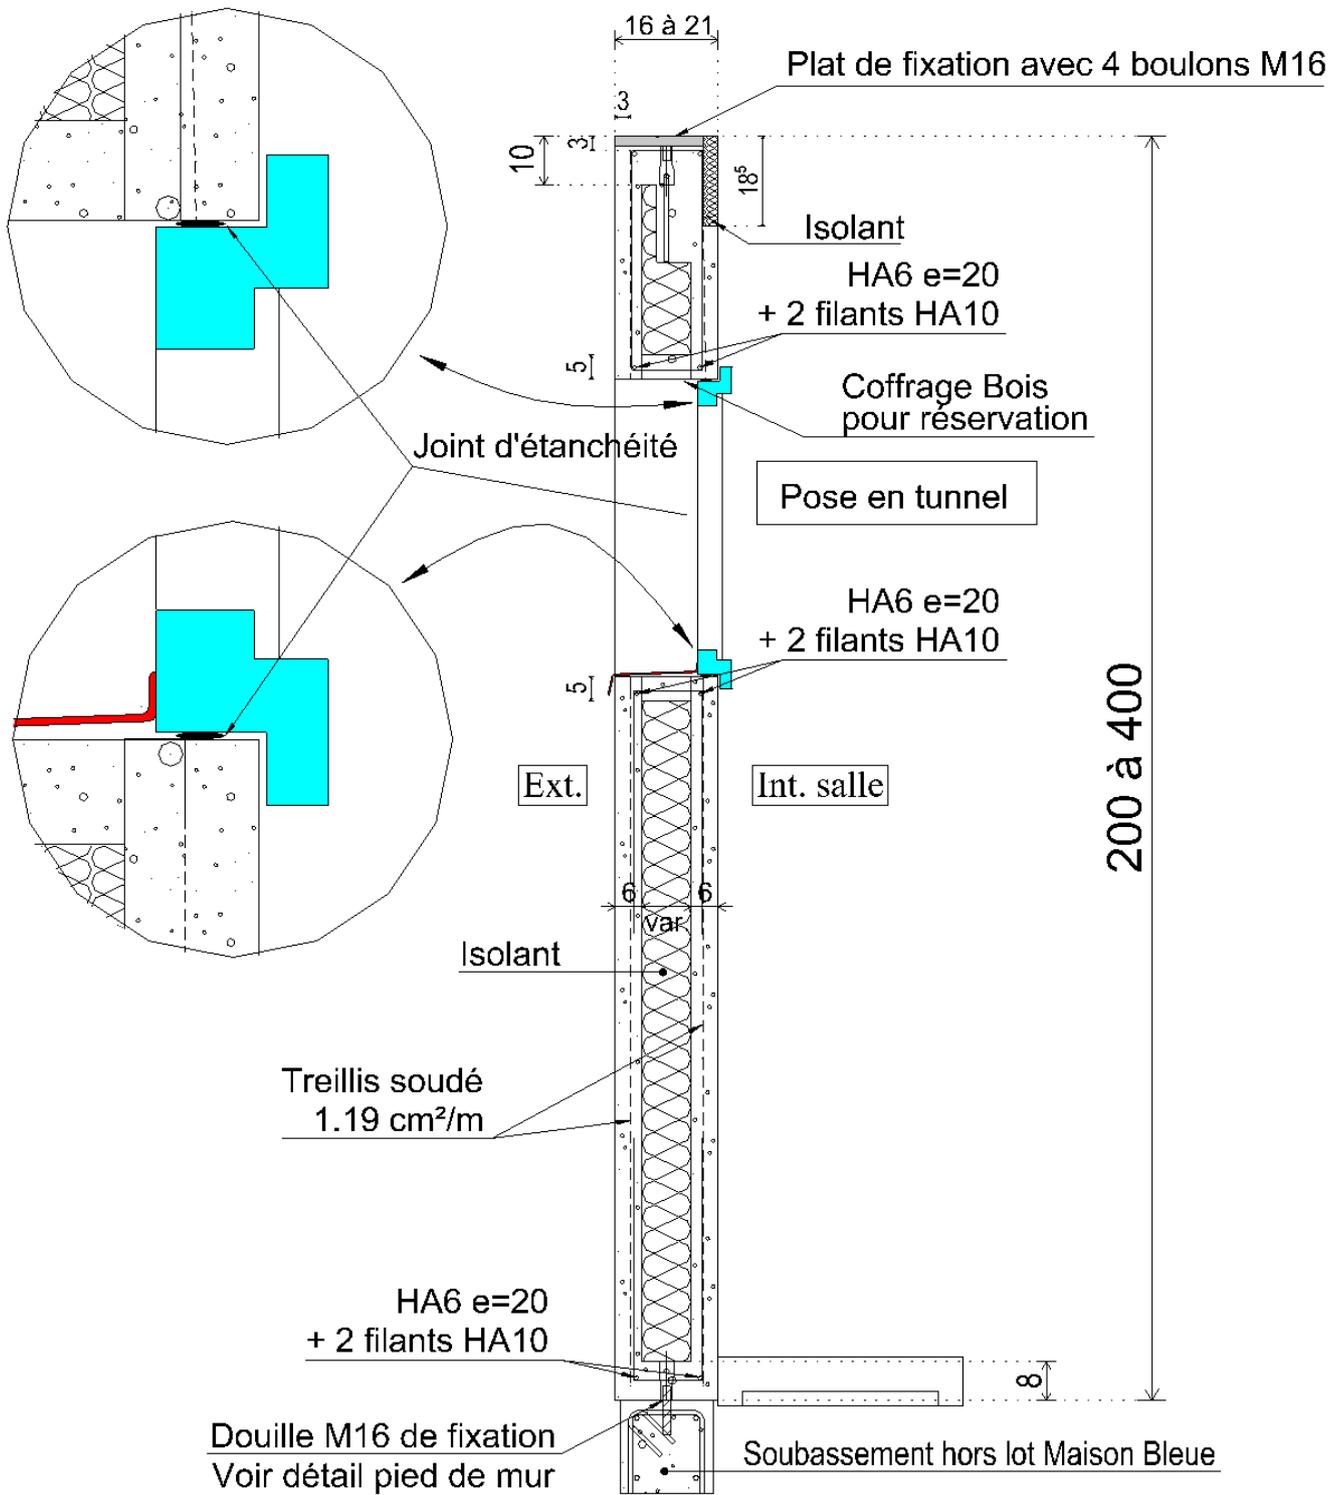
Panneaux sandwichs de façade posés sur soubassement – détail pied de mur
